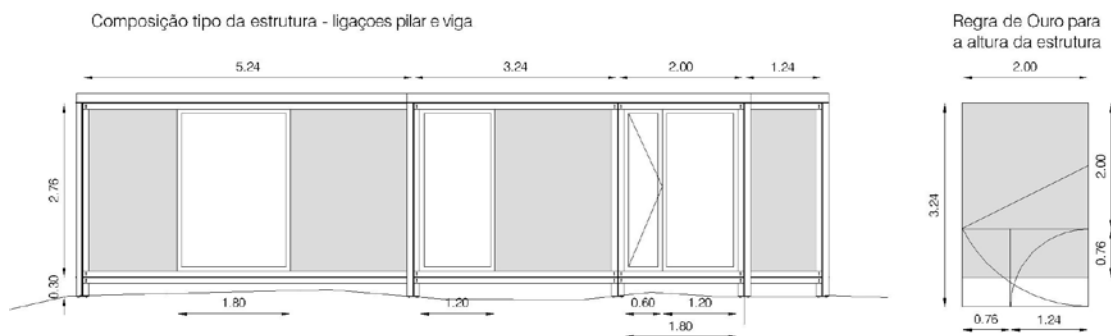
Composição dos módulos em alçado (ligação com os pilares e vigas - cruz grega)
